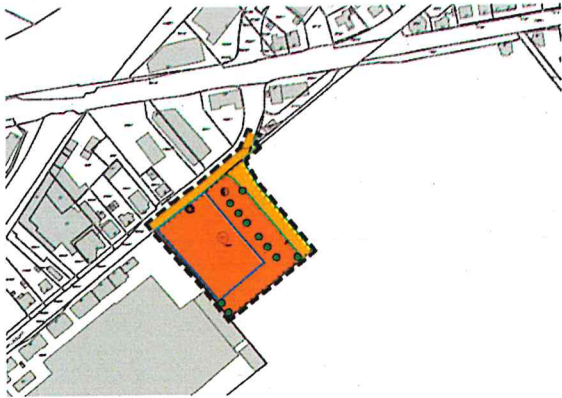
Planungsstand vorhabenbezogener Bebauungsplan Lebensmitteleinzelhandel COEUR
